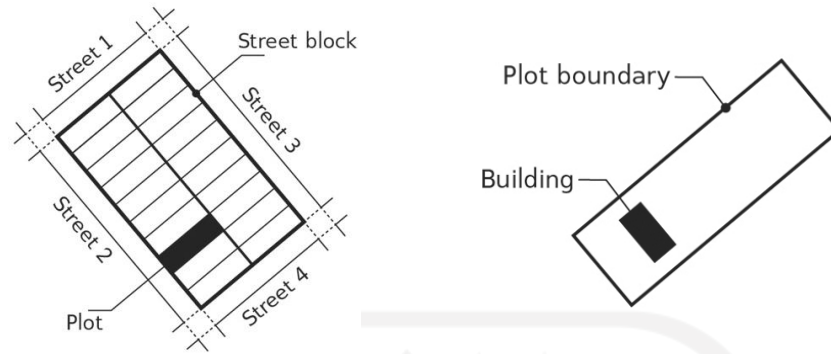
11 Layout Bangunan Pembagian Ruang
